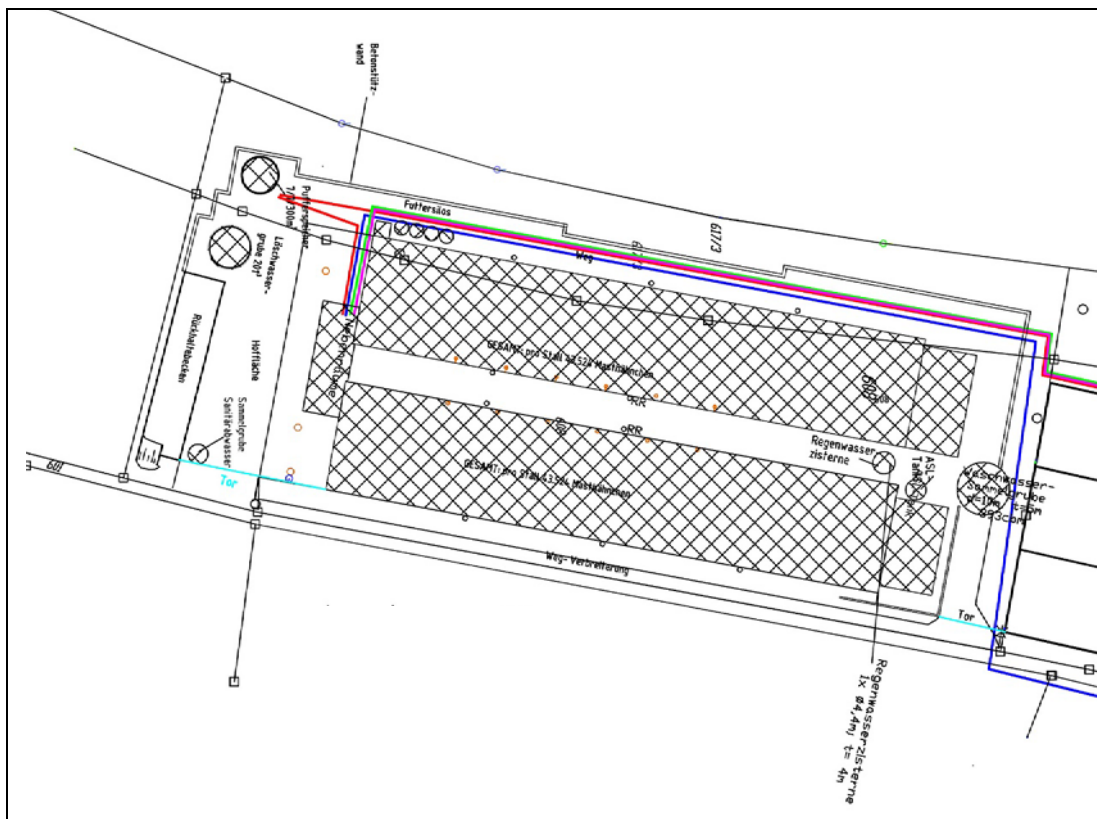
Lageplan mit Darstellung der geplanten Masthähnchenställe MHS_4 und 5
